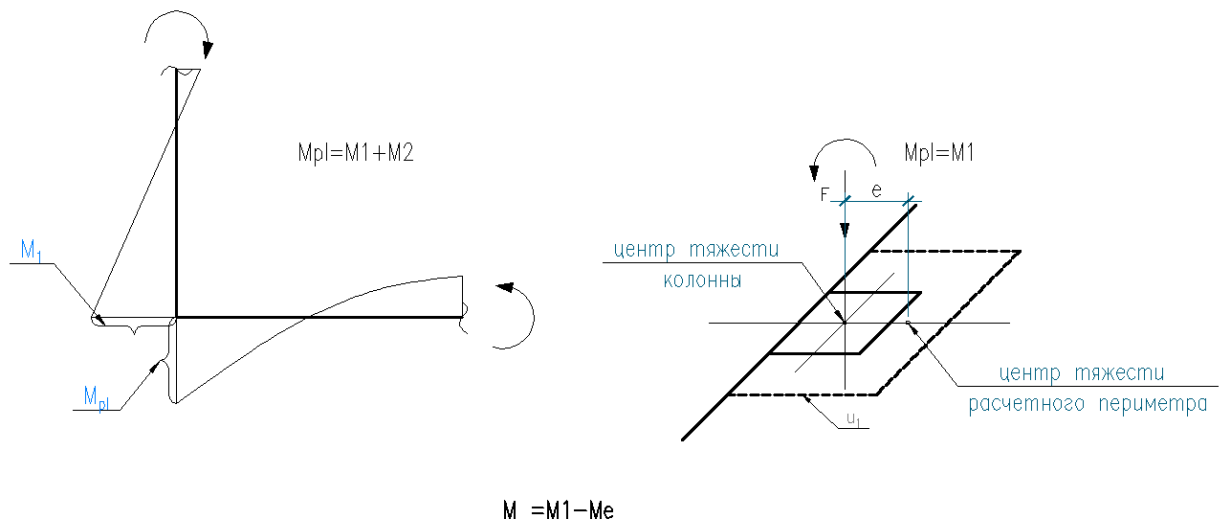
Расчетные усилия в фундаментной плите при опирании на крайние колонны.
